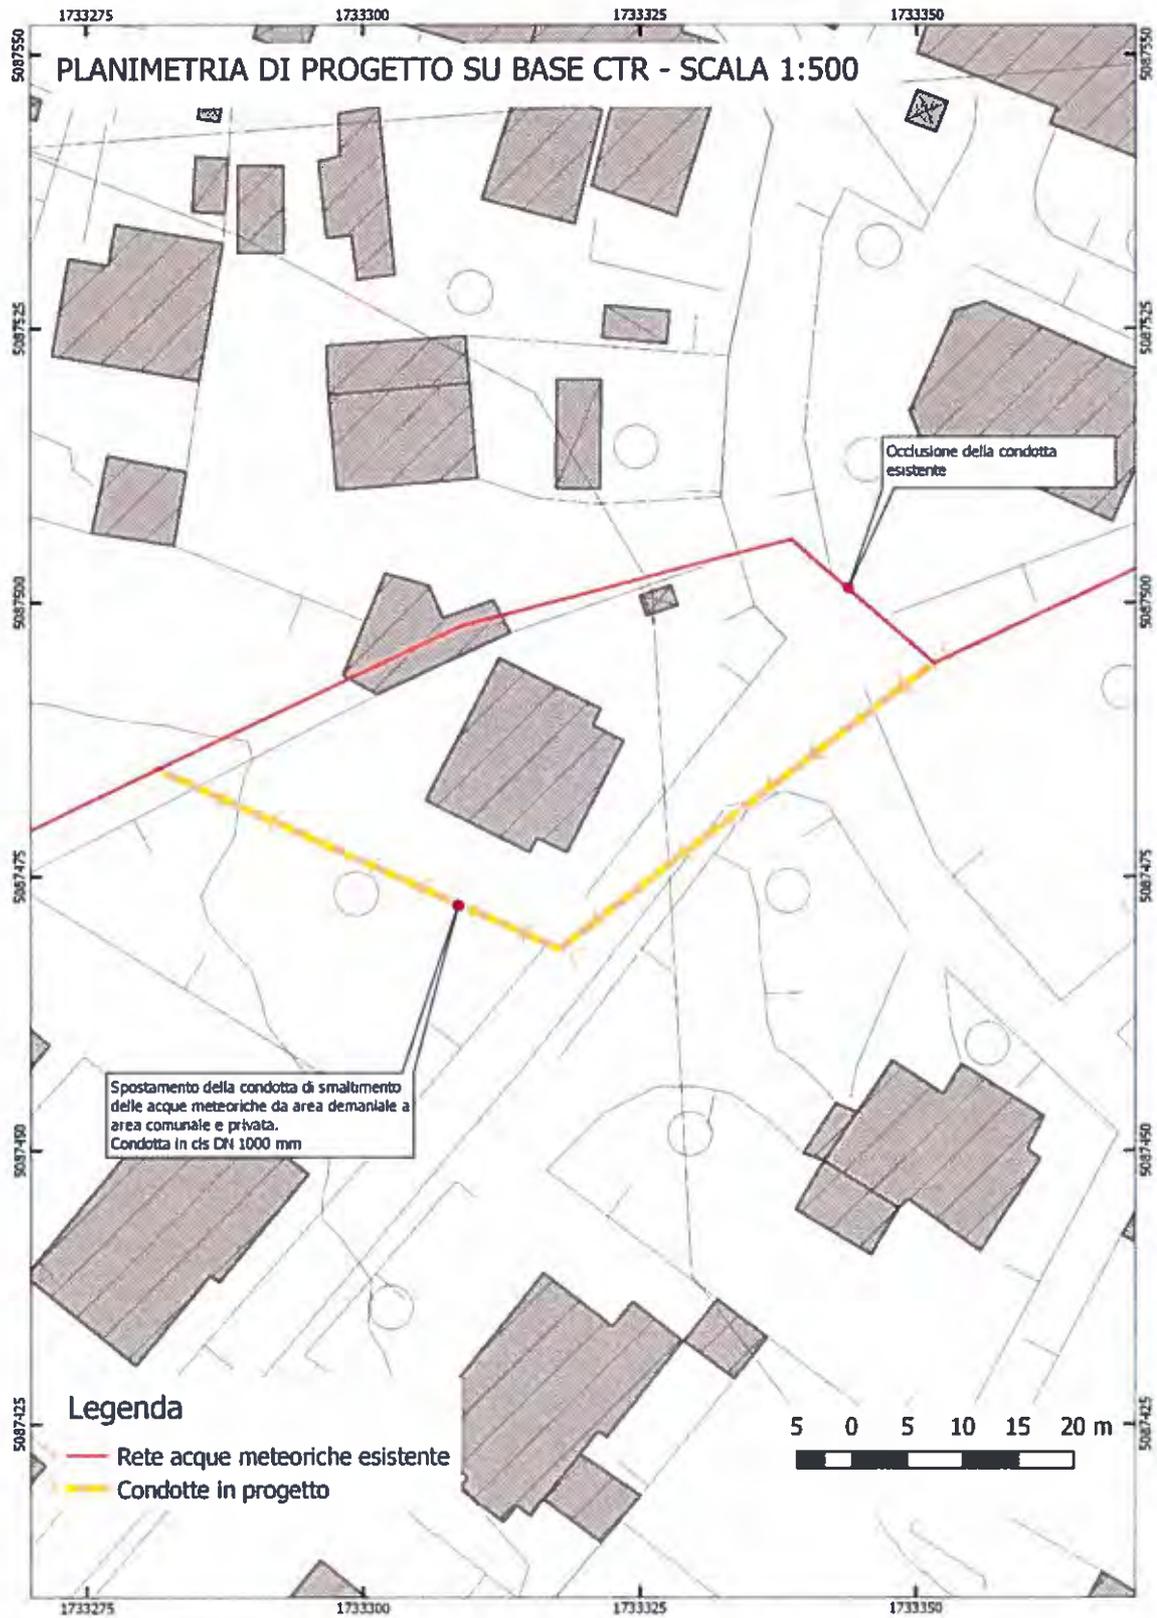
Intervento n.6 – Sistemazione nodo idraulico di Via Della Morte- Planimetria di progetto
